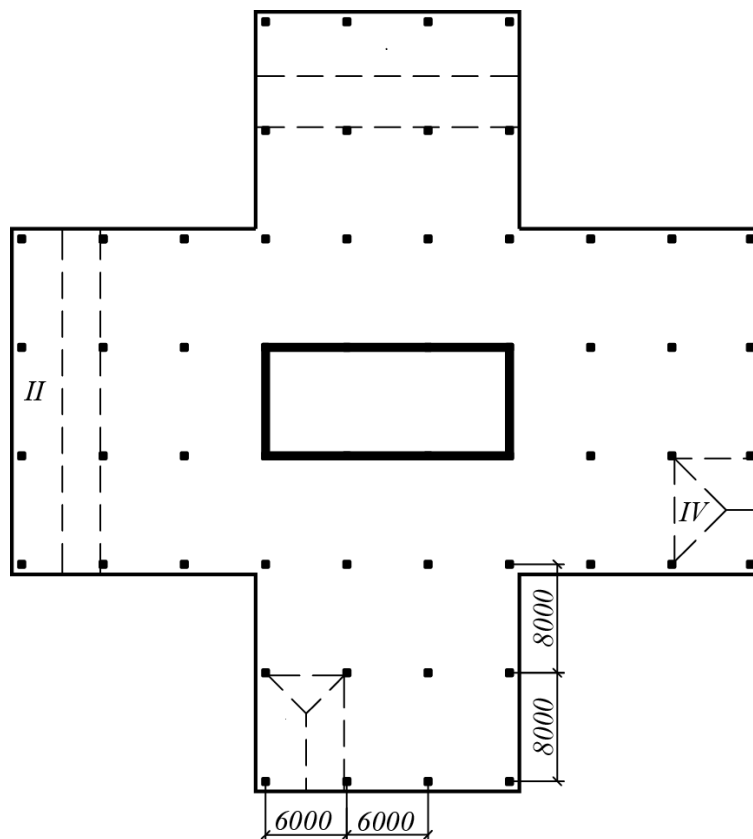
Механизмы разрушения безбалочной бескапитальной плиты перекрытия
